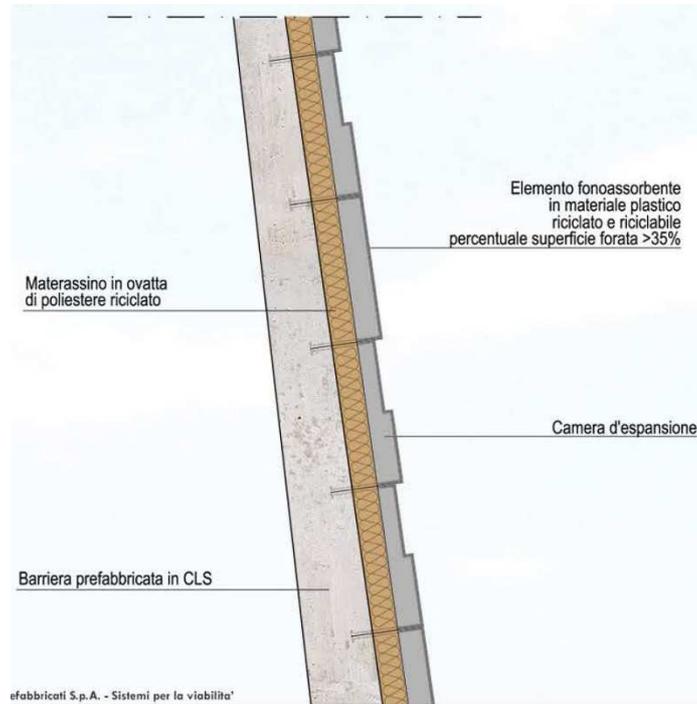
ESEMPIO DI PARTICOLARE DELLA SEZIONE TIPO DEL PANNELLO ACUSTICO
